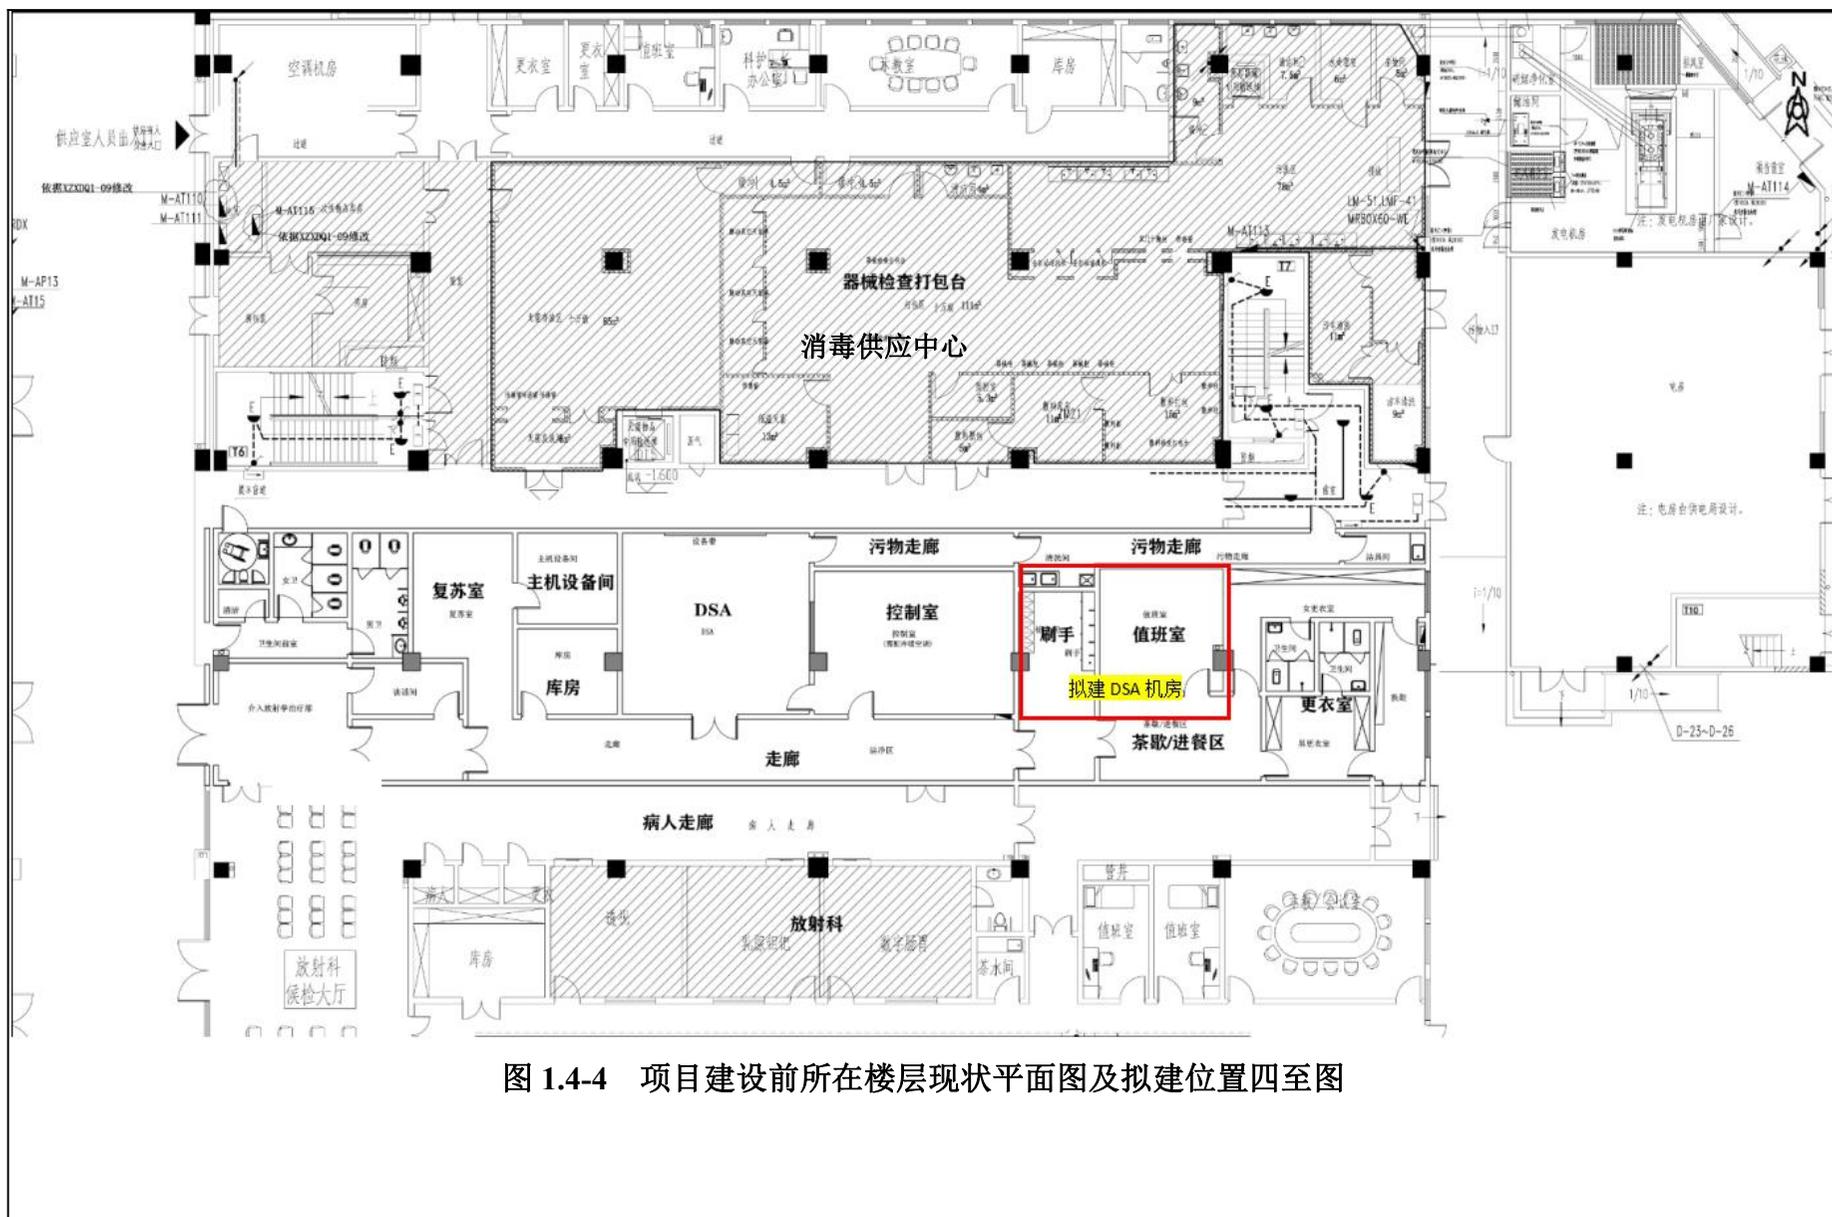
项目建设前所在楼层现状平面图及拟建位置四至图
